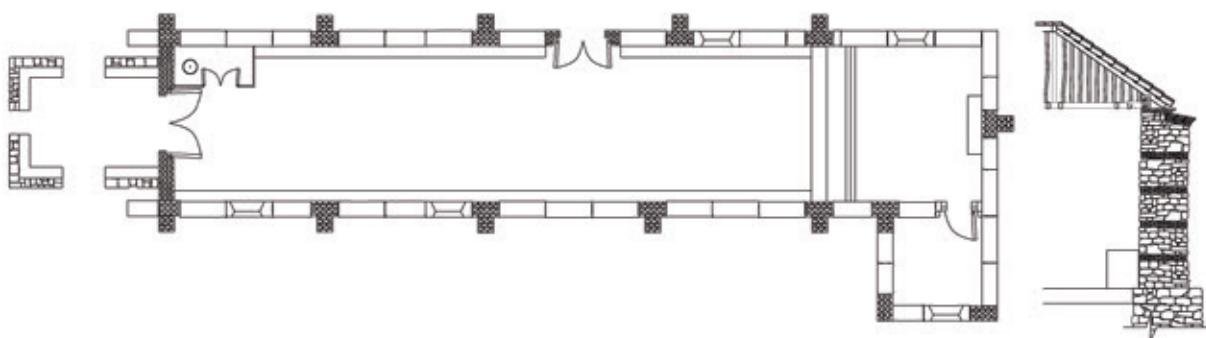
Traza de la iglesia de Sora-Furaquirá-Capitanejo de Motavita, con algunos contrafuertes en adobe. Planta general y corte del muro testero<sup>32</sup>.
